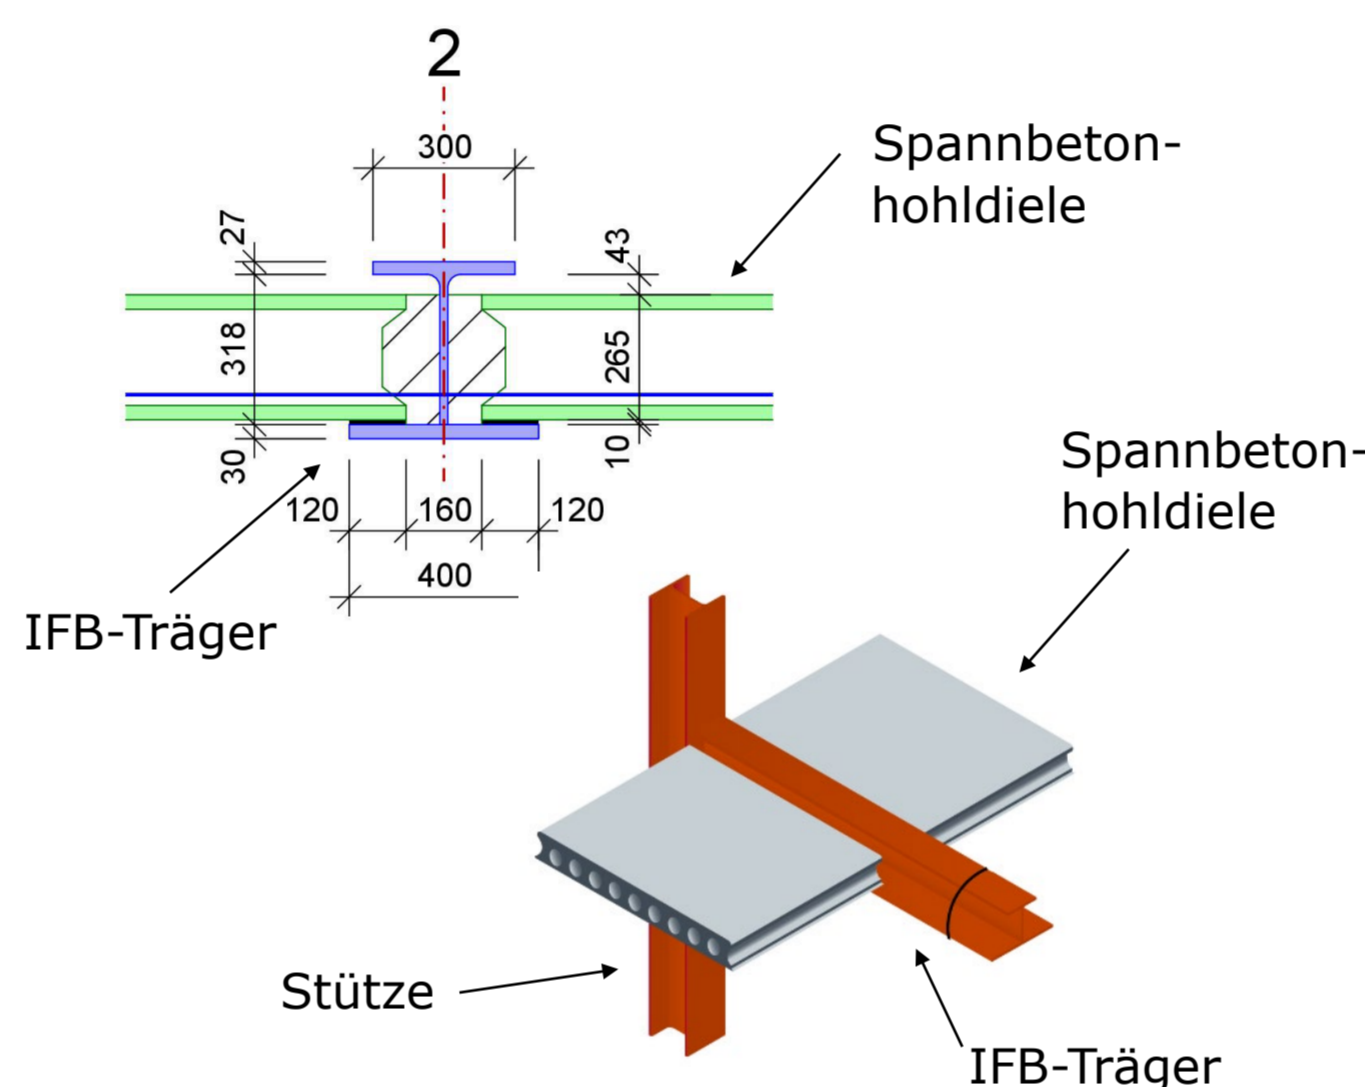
Detail Anschluss Hohldiele Slimfloor
